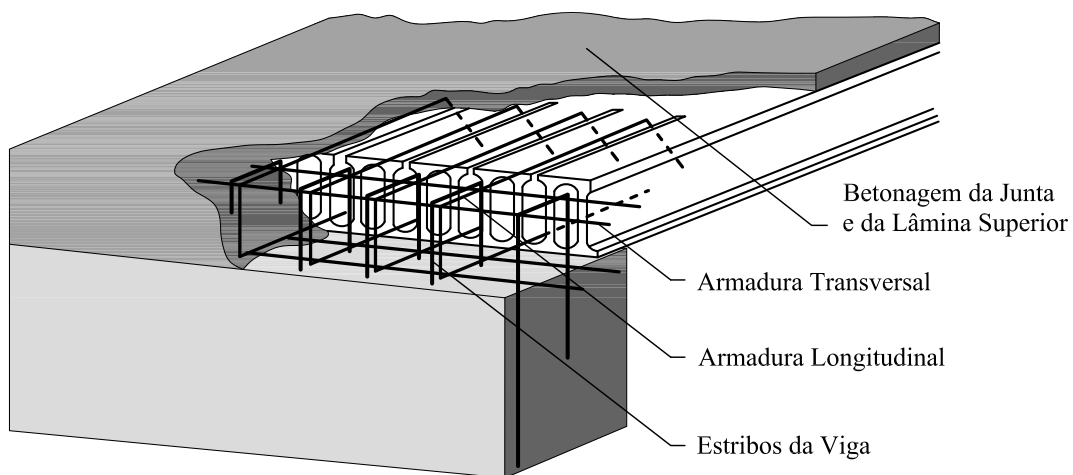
Ligação laje - viga com betonagem da zona superior, adaptado de [6]
